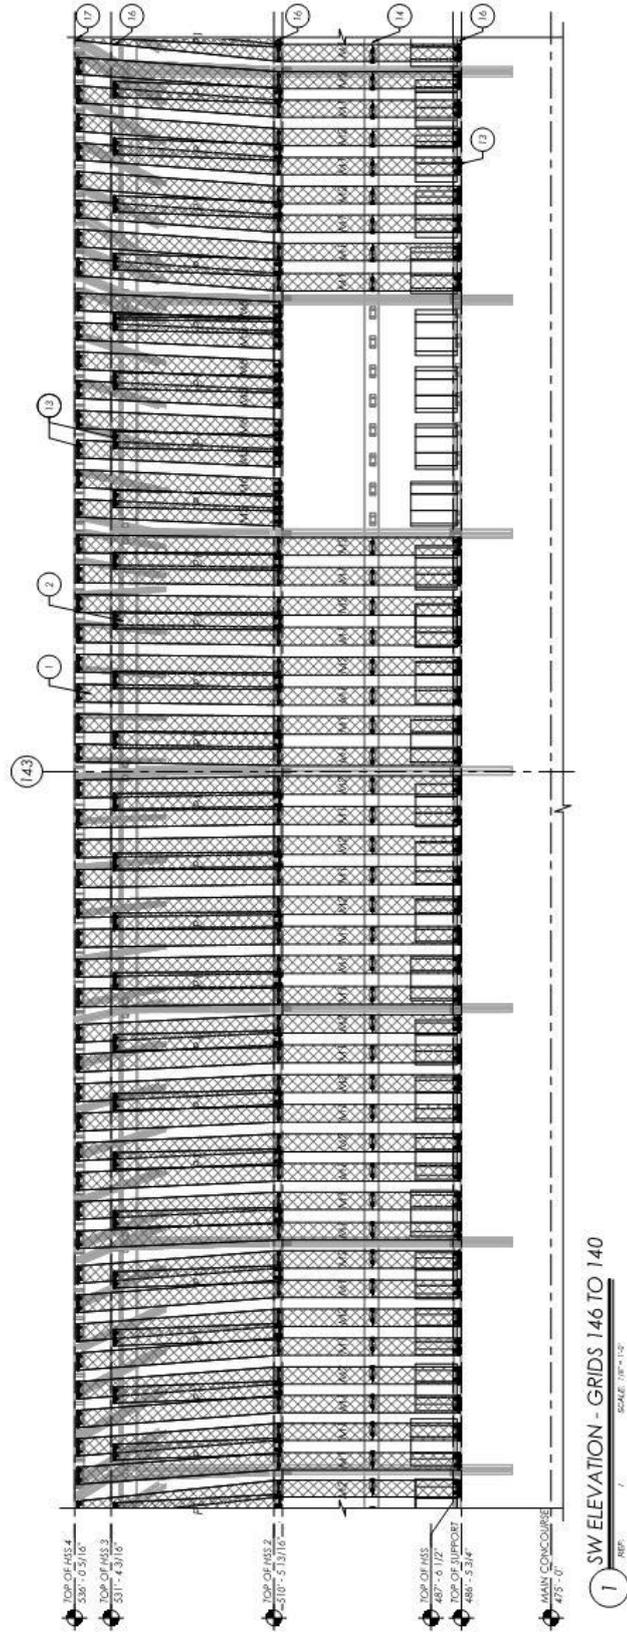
Elevación de una porción de la zona Suroeste. En la misma se puede observar la zona en la que los paneles son de menor longitud debido a la entrada al estadio.
